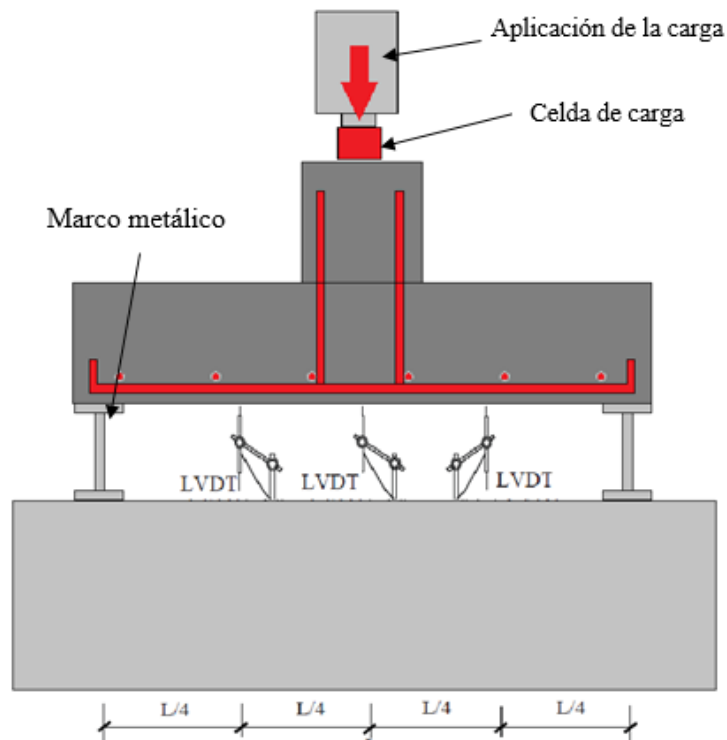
Esquema del montaje para fallas por punzonamiento en un sistema losa-columna.
